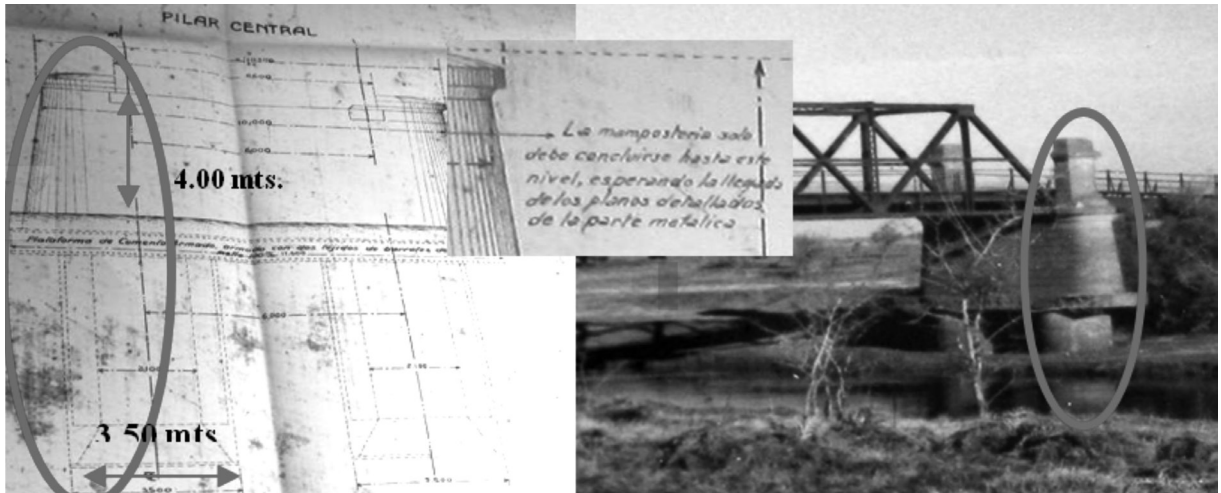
Corte transversal de pilar y las fundaciones. Foto anterior al reemplazo de la estructura.
